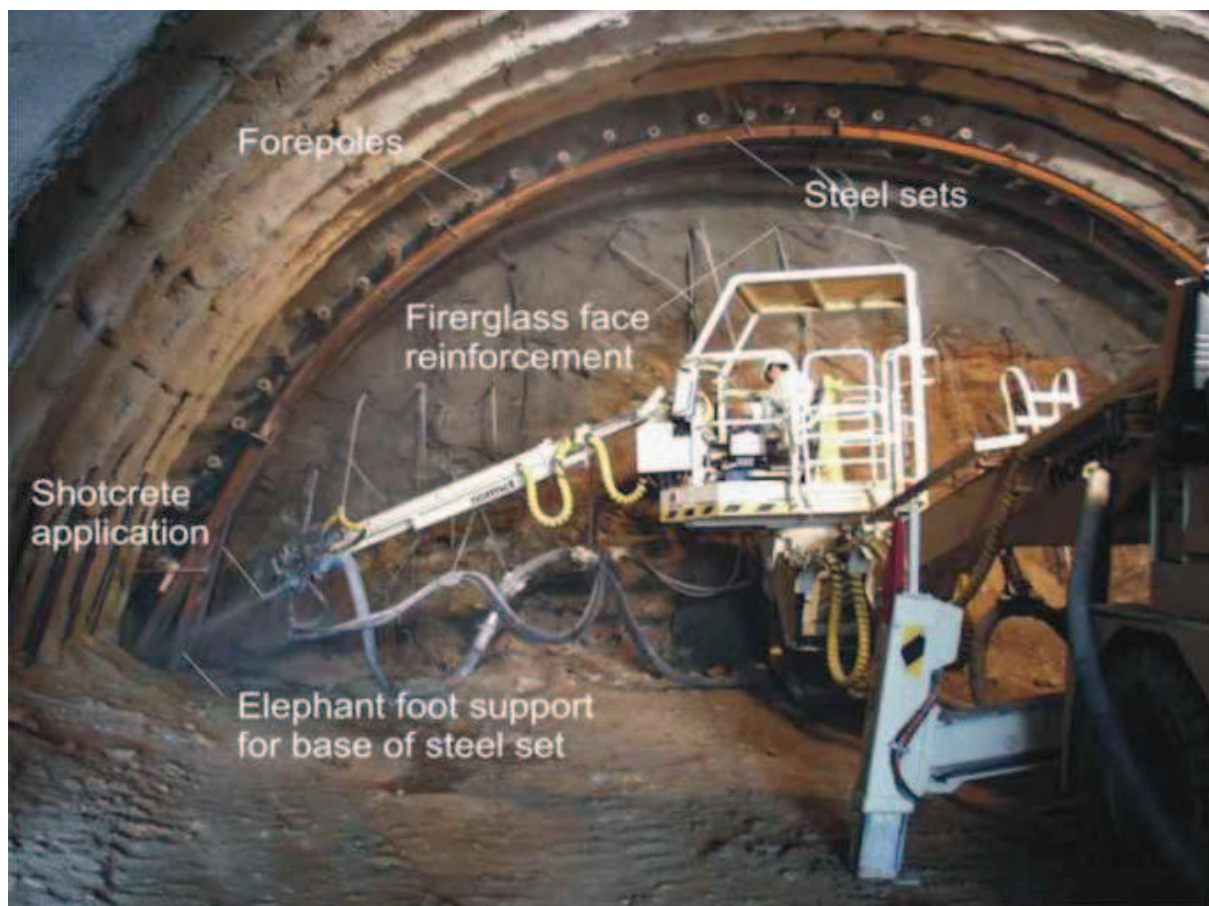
Exemplo de uma aplicação típica de suporte onde se destaca a aplicação de betão projectado (shotcrete application), enfilagens (forepoles), cambotas de aço (steel sets), pregagens de fibra de vidro na frente de escavação (fiberglass face reinforcement) e reforço da fundação das cambotas (elephant foot support for base of steel set) [18].
